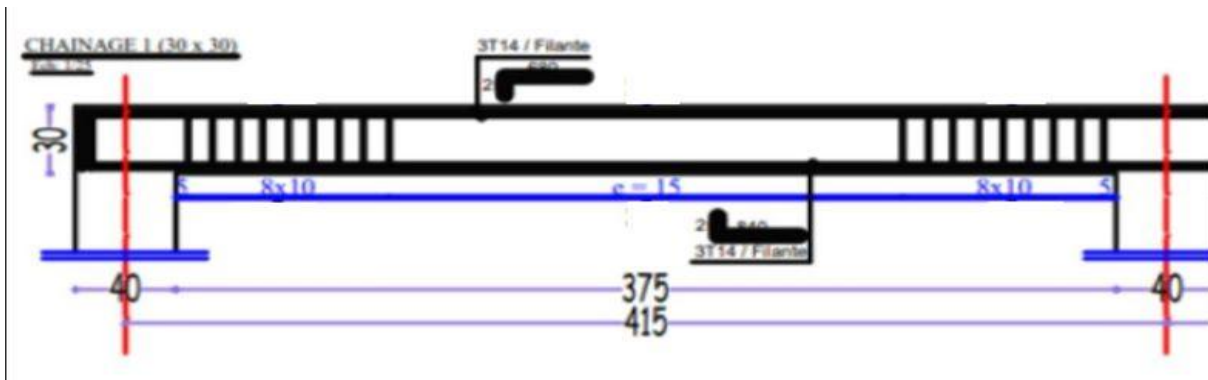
FERRAILLAGE DE POUTRE CHAINAGE.
